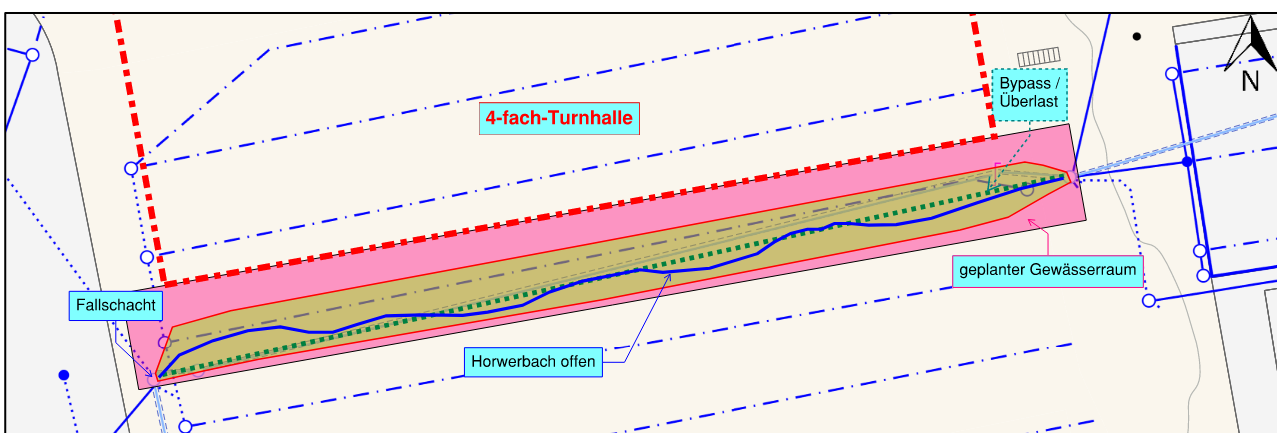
Situation mit dem Bypass in ein Rückhaltebecken
